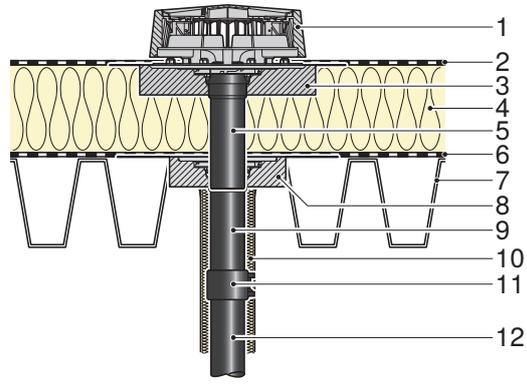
Монтаж на изолированной легкой кровле с кровельным покрытием и креплением пароизоляции
